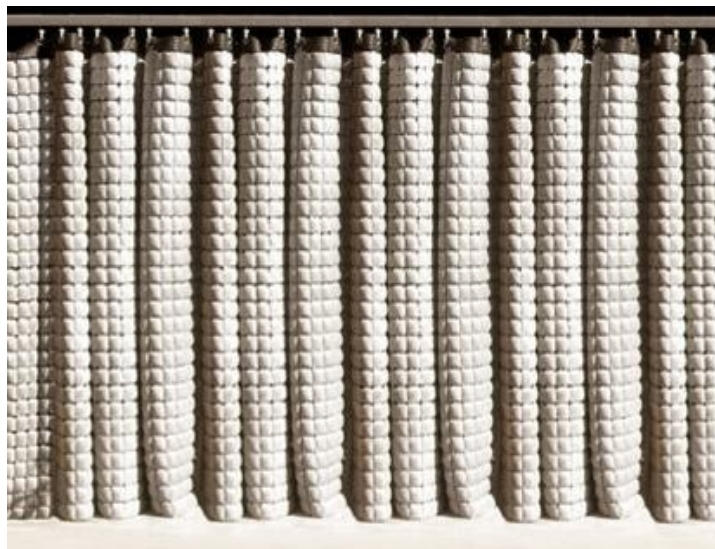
Detalles del proyecto betonvorhang de Memux, 2005, Viena.
